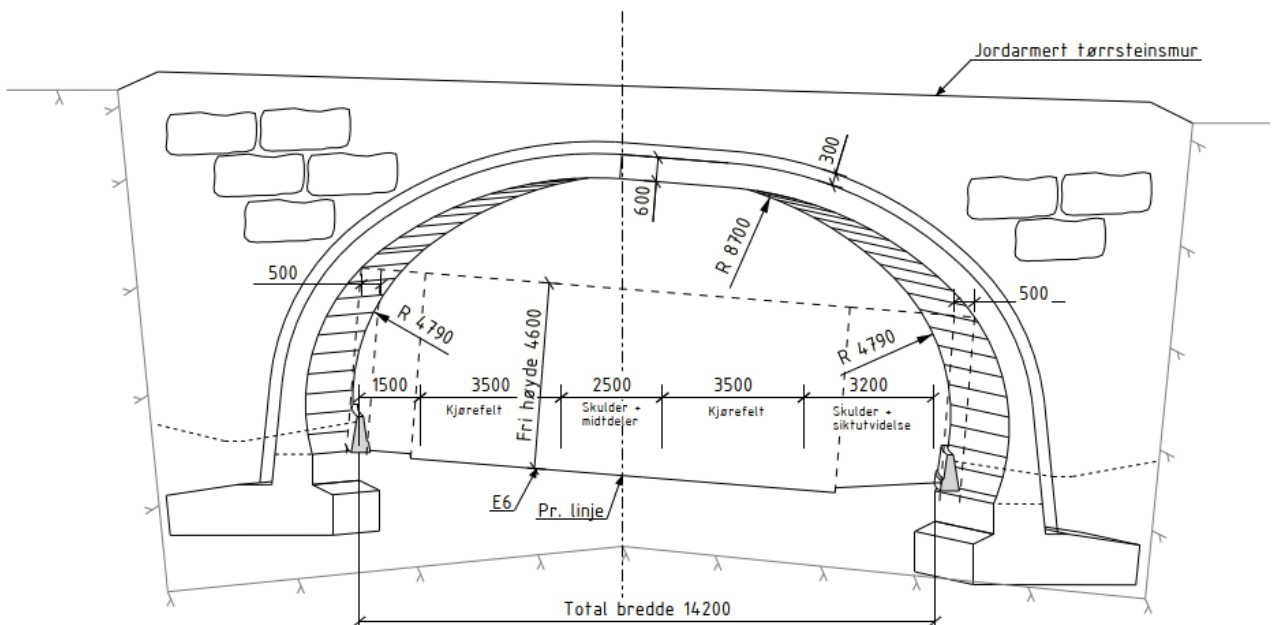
Illustrasjon av tunnelportalen med overgang til Orklabrua
